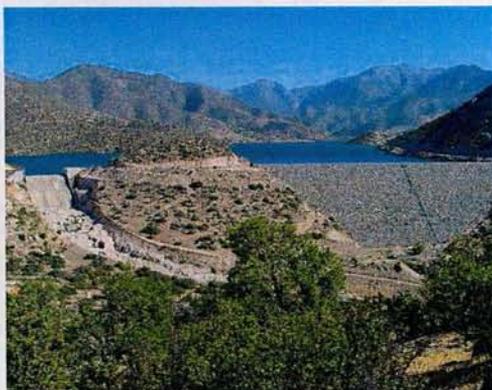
Vista Presa y Aliviadero de Crecidas Embalse Corrales.
